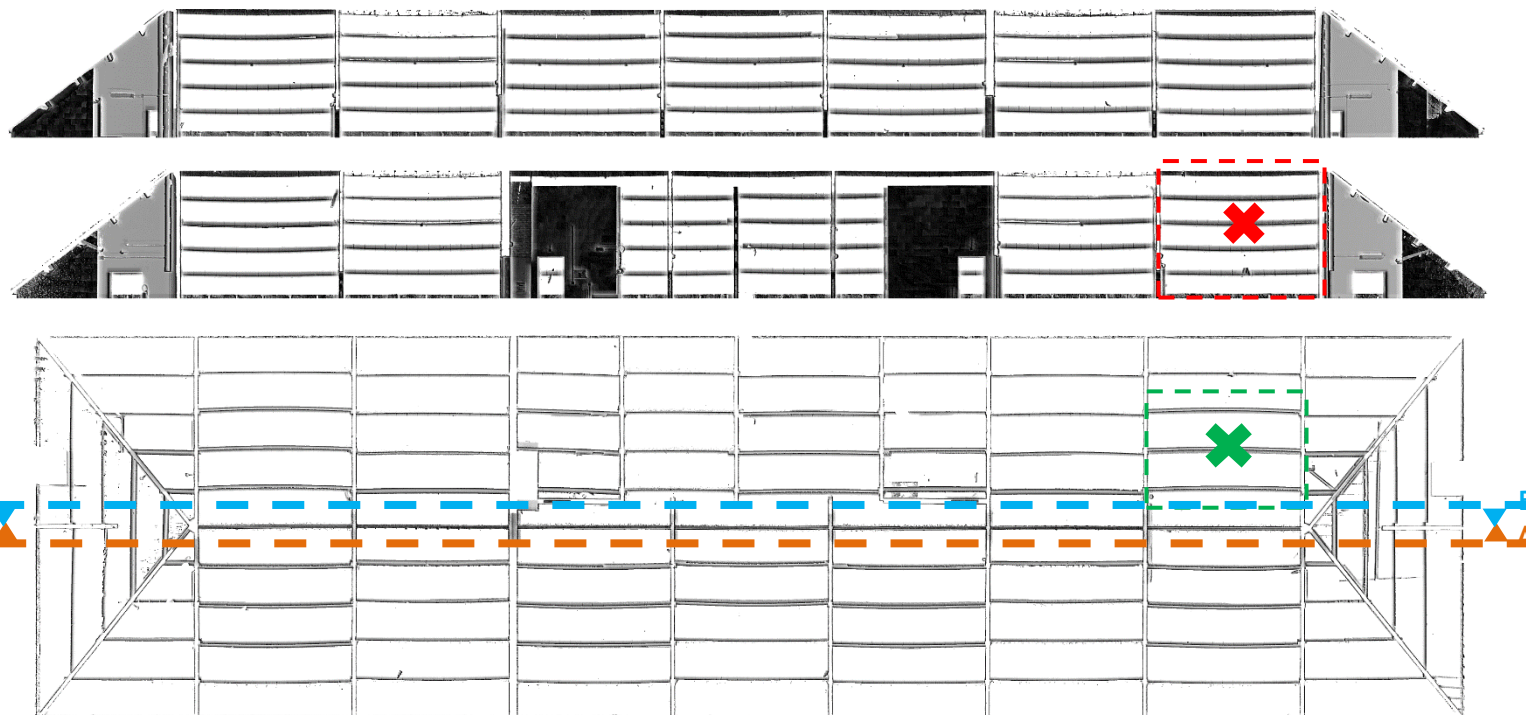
Bâtiment 116 - De haut en bas : Coupe AA', Coupe BB' et plan de charpente d'après les relevés lasergrammétriques
